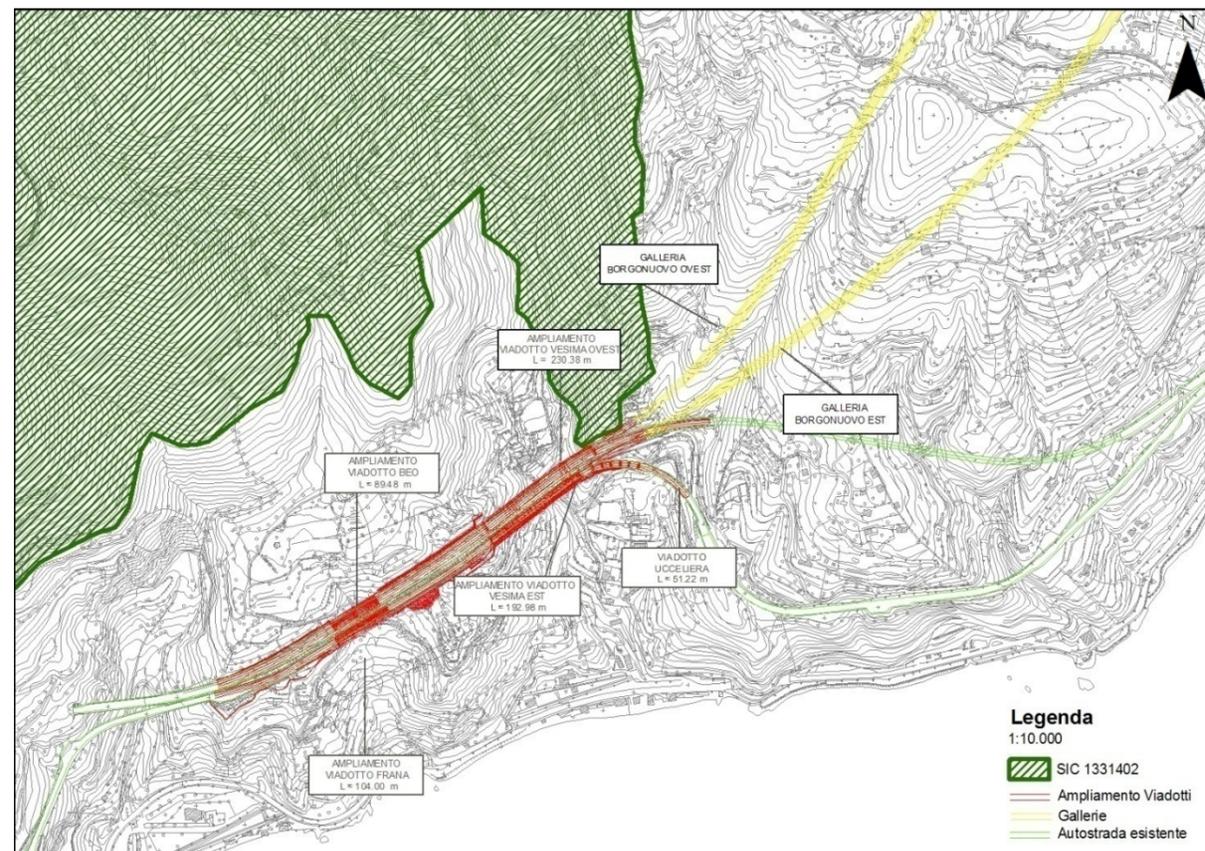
Localizzazione del tracciato rispetto al SIC
